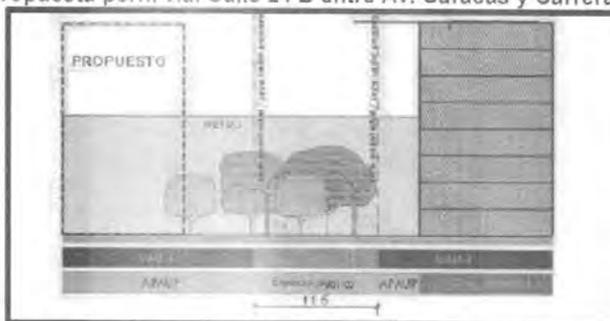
Propuesta perfil vial Calle 24 A entre Av. Caracas y Carrera 13 A
